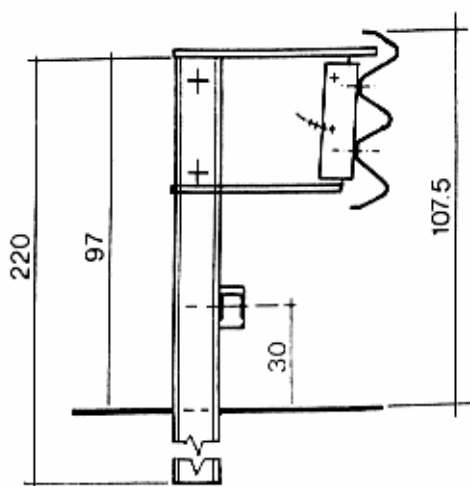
Barriera metallica con a tripla onda con distanziatore a “frattura prestabilita”.
